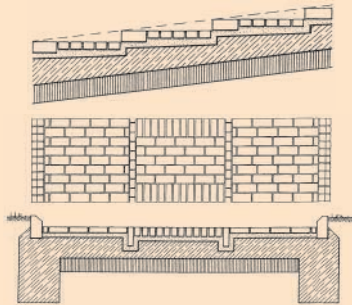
Entrada pavimentada de garaje. La zona de circulación se dispone como rampa con adoquines cerámicos colocados a tizón, mientras que la zona peatonal se configura como escalera en el centro. La capa de zona peatonal se coloca en lecho de mortero alternando a tizón y a sogá. Las zonas de confluencia constan de adoquines cerámicos en vertical. En la capa portante de hormigón se prevé la pendiente necesaria.
